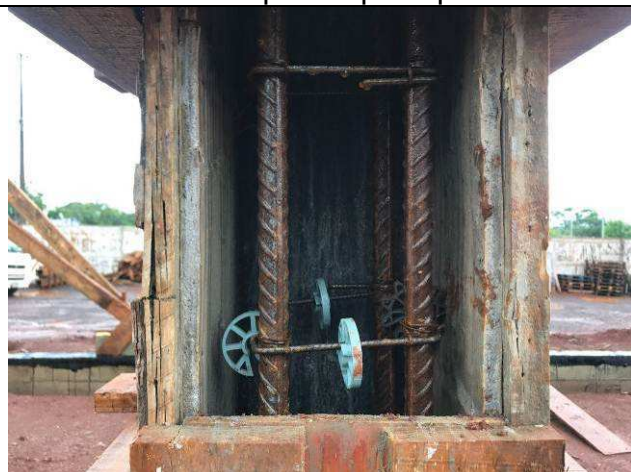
C: Formas e armaduras do pilar P67 do prédio principal.
